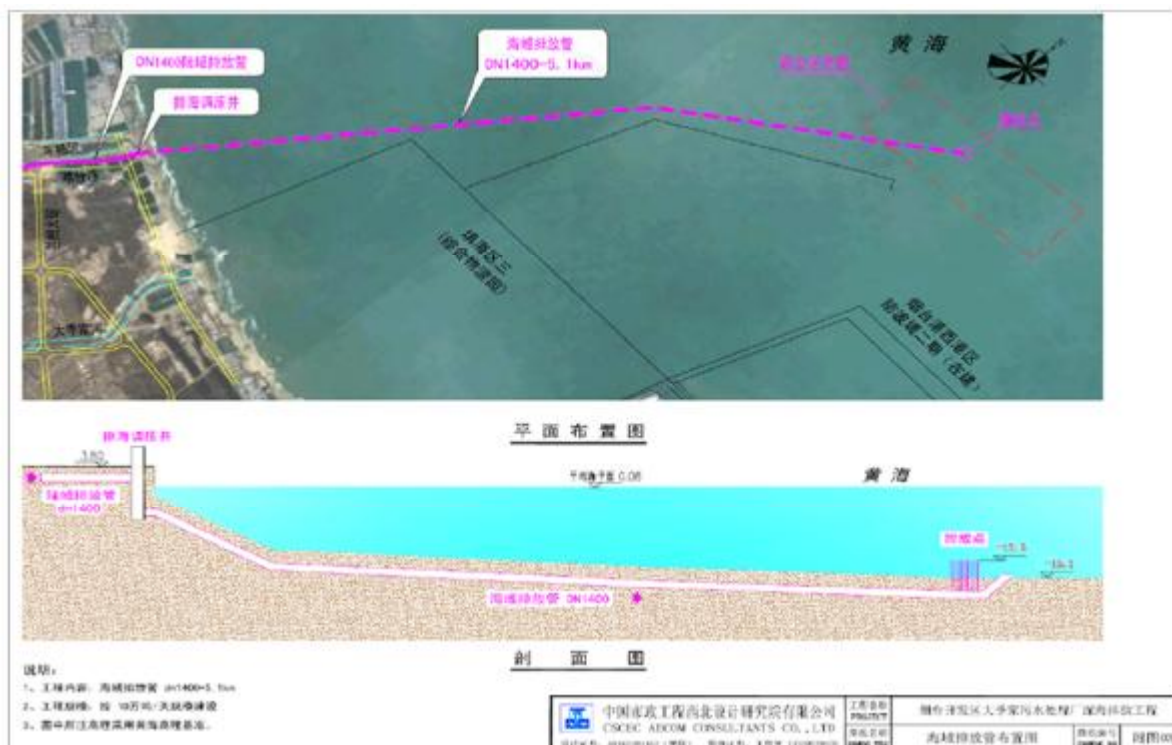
新城污水处理厂排海管线工程平面布置图
